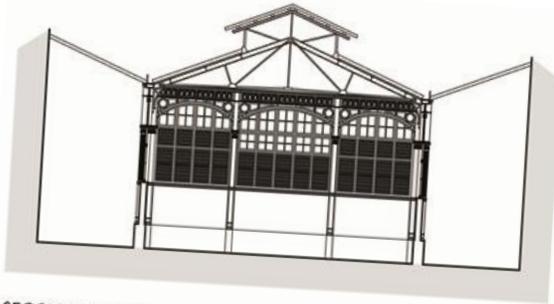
Panorámica acceso a la zona de pescadería, Mercado Central de Abastos de Jerez.
